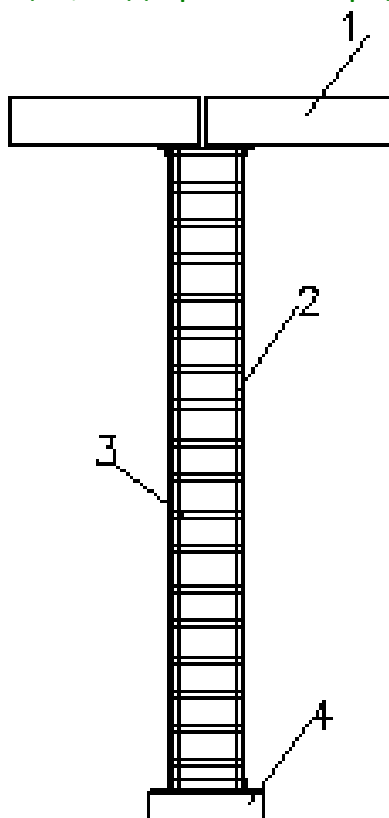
Усиление колонны (столба) стальной обоймой: 1- балка; 2 – вертикальный уголок обоймы; 3 – планка из полосового металла; 4 – обрез фундамента.
